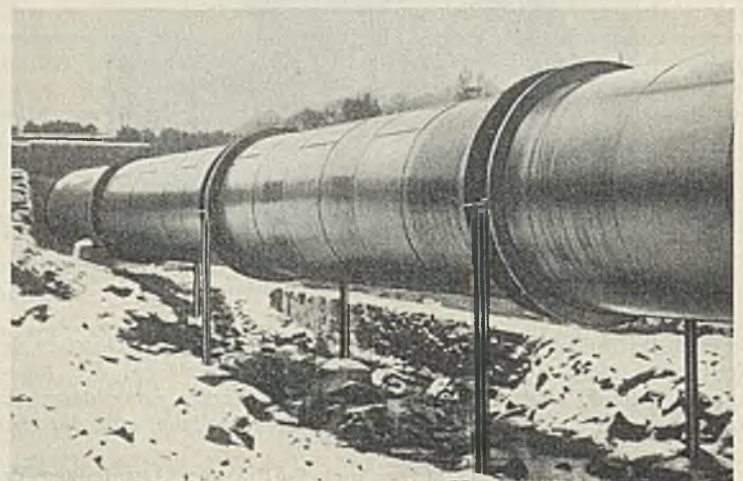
Weitspannrohrleitung beim Kraftwerk Kungfors (Schweden): 3,3 m l. W., 12,5 m Stützenabstand, 6 bis 7 mm Wandstärke (Vattenbyggnadsbyran, Stockholm).
